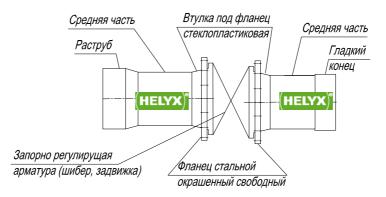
Фланцевое соединение патрубков под фланец с запорно-регулирующей арматурой на стальных свободных фланцах на концах.
